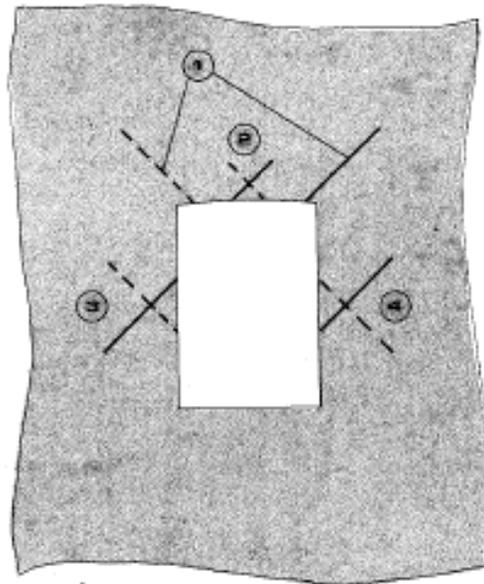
Particolare della cucitura delle aperture eseguita nel progetto di risanamento conservativo dell'ing. E. Carravetta
